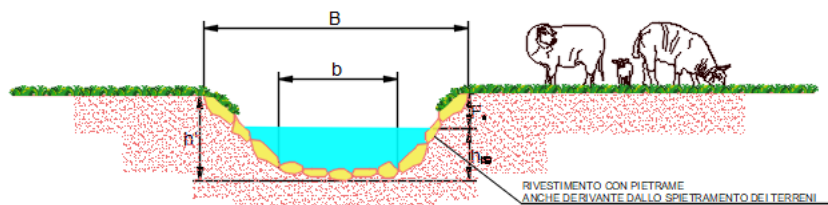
Estratto elaborato TRO.ENG.TAV.097.0A_PLANIMETRIA IMPLUVI
